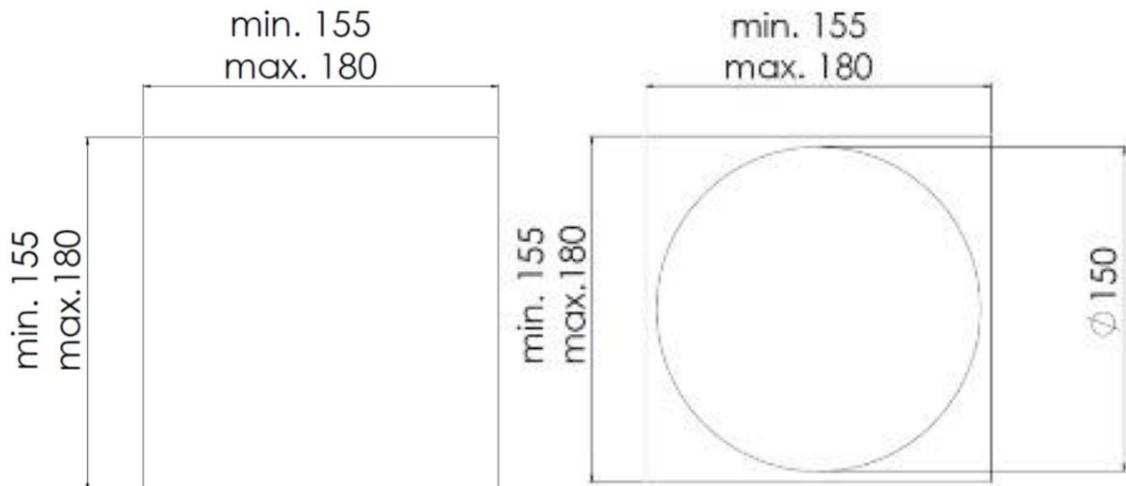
Ausschnitt für Stahlbau mit Kernbohrung
